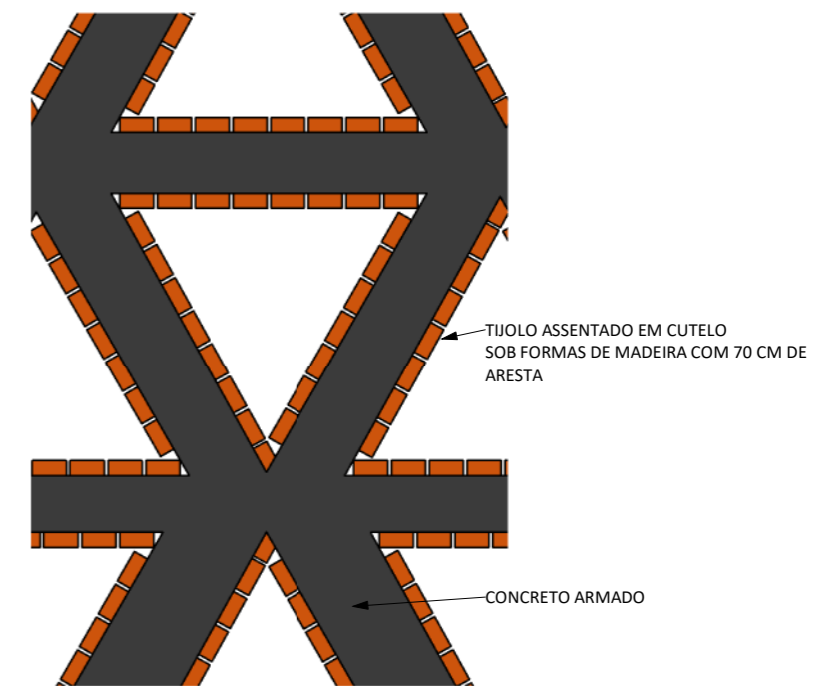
Vista de detalhe B: Tijolos do borboletário. 1:25. Elaborada por Ana Coêlho.
